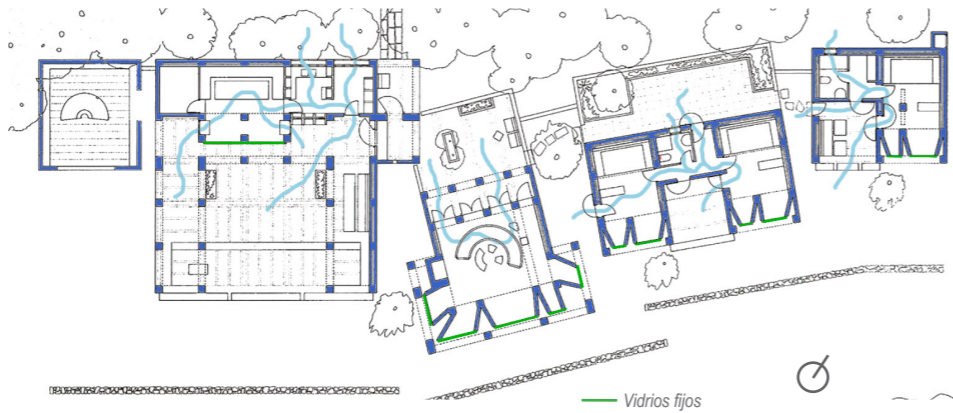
Planta ventilación. Imagen con intervención propia.
